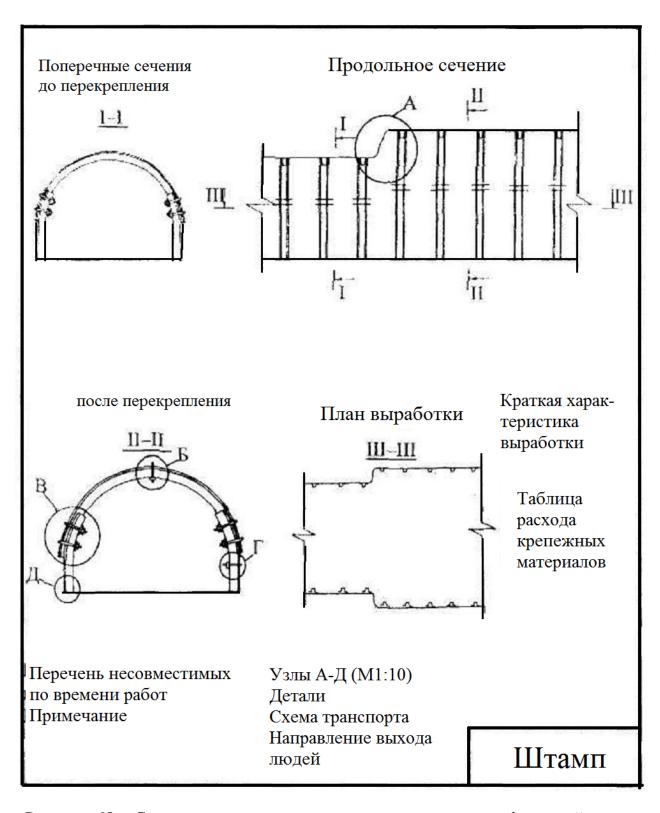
Схема размещения на листе составляющих графической части «Паспорта перекрепления горизонтальной выработки»
